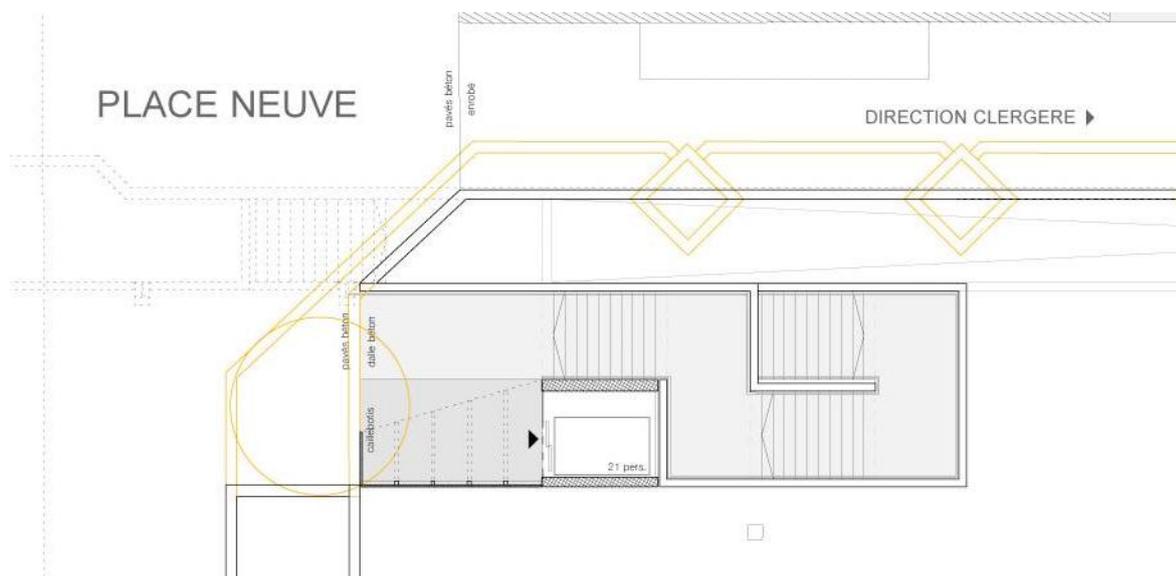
Liaison centrale verticale _ vue en plan niveau pl. Neuve _ échelle : 1/200
